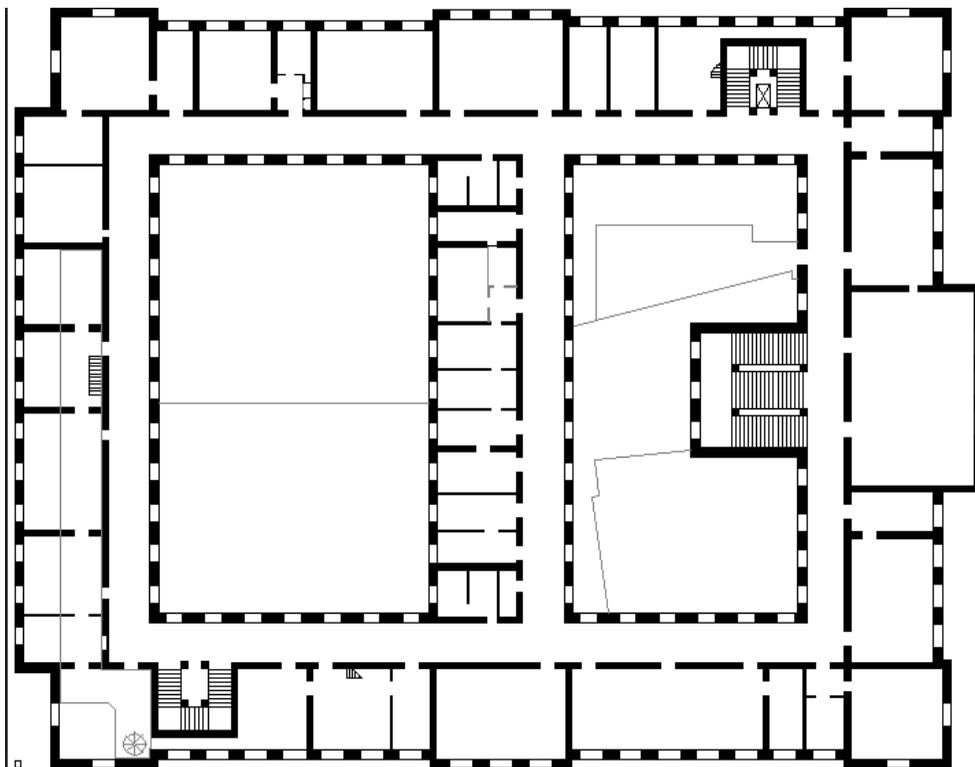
Grundriss des Hauptgebäudes in der Rechbauerstraße 12. Zwei Innenhöfe, der östliche ist verbaut.
